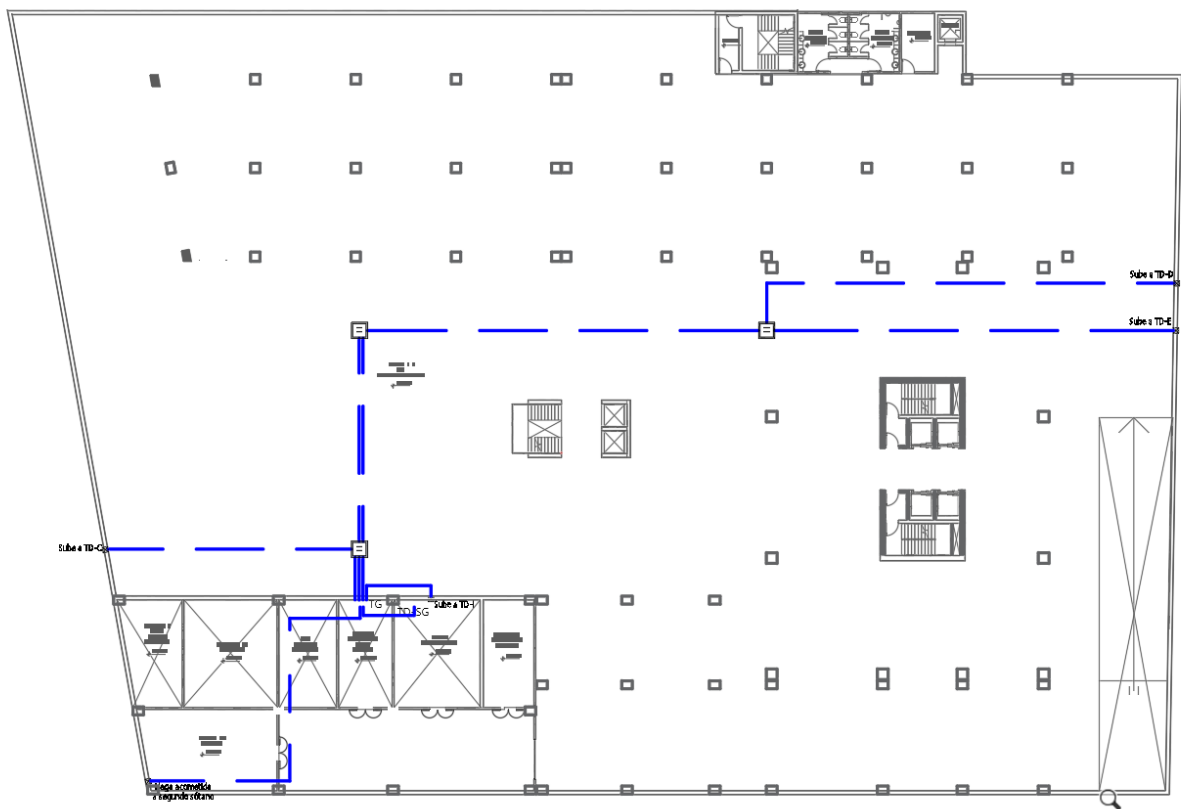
Plano de segundo sótano. Fuente: Elaboración propia.
